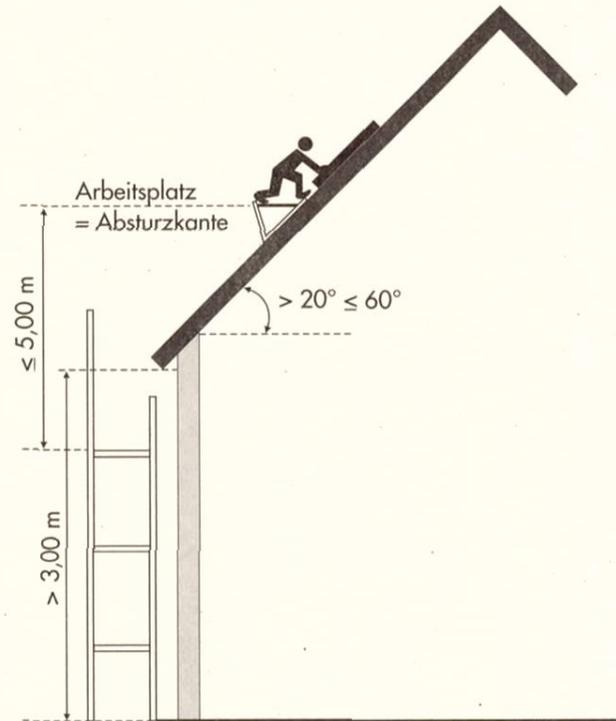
Dachfangerüste für Arbeiten auf geneigten Dachflächen.
